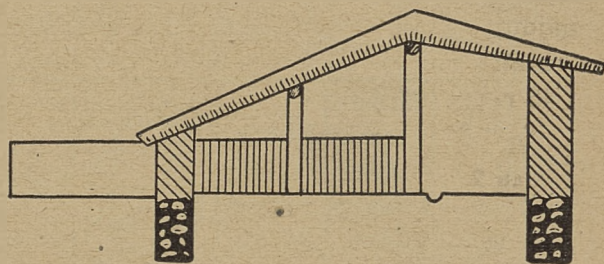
Plan chlewa typu maneżowo-legowiskowego.
